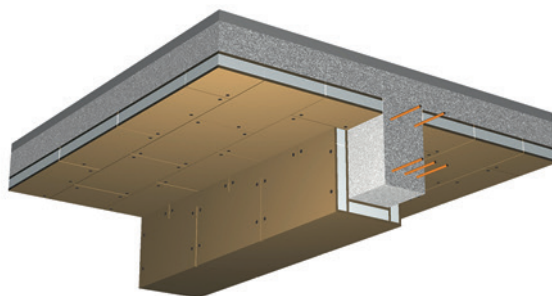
Isolation des poutres à retombées pour la technique du fond de coffrage
